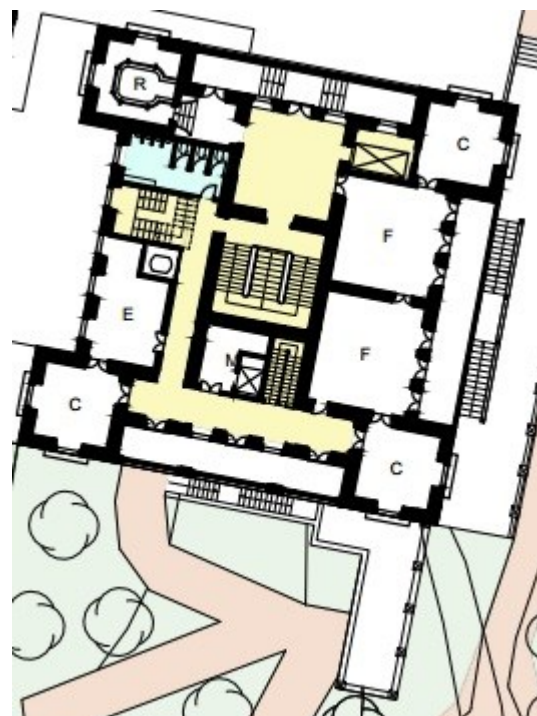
Planta do Palácio, Piso 1, autoria própria
